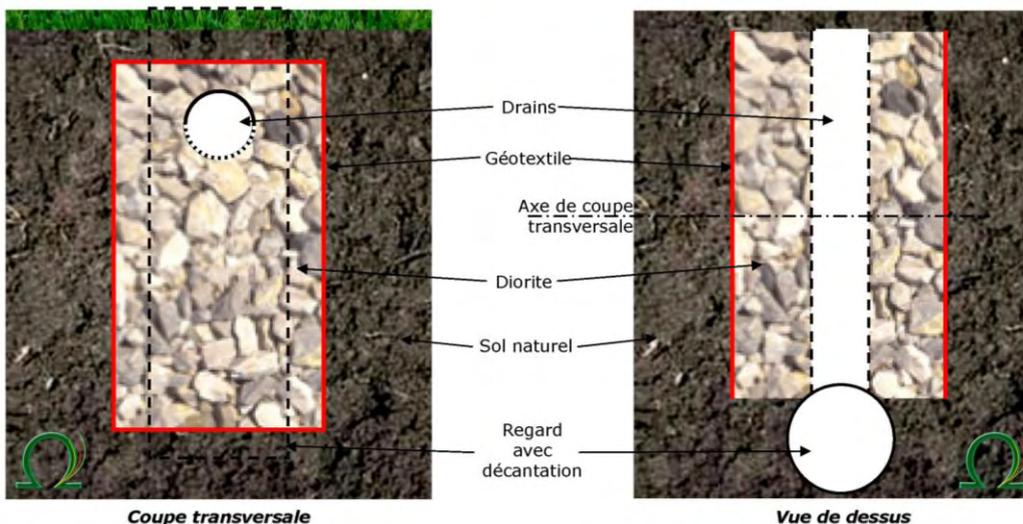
coupe de principe d'une tranchée drainante pour l'infiltration des eaux de toitures
